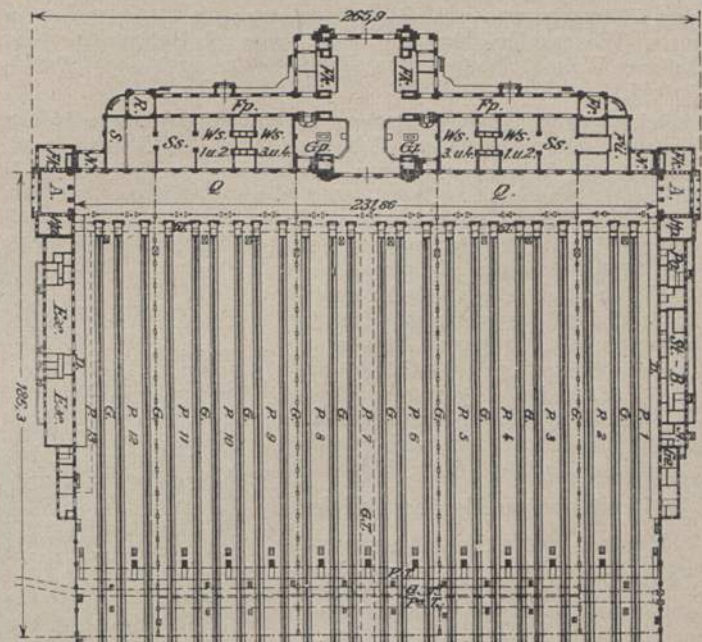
Bahnhof Frankfurt a. M. (Grundriß).
